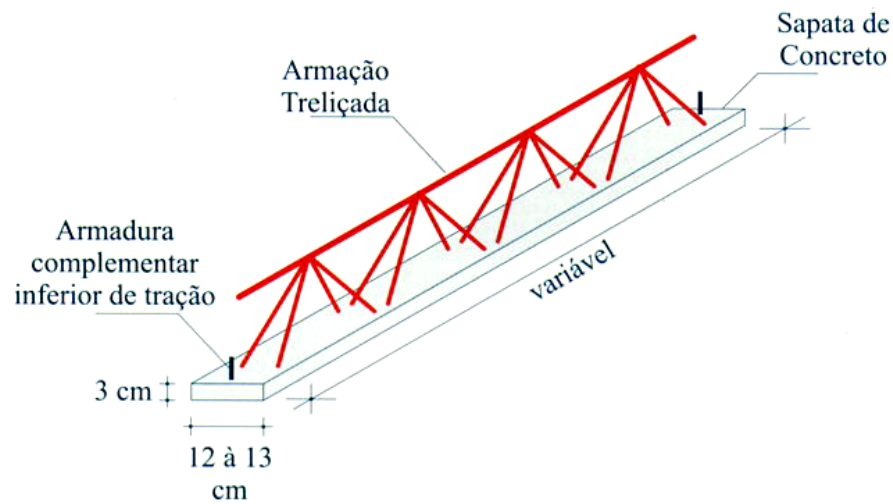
Vigota treliçada (LAJES FAULIM, 1998).
